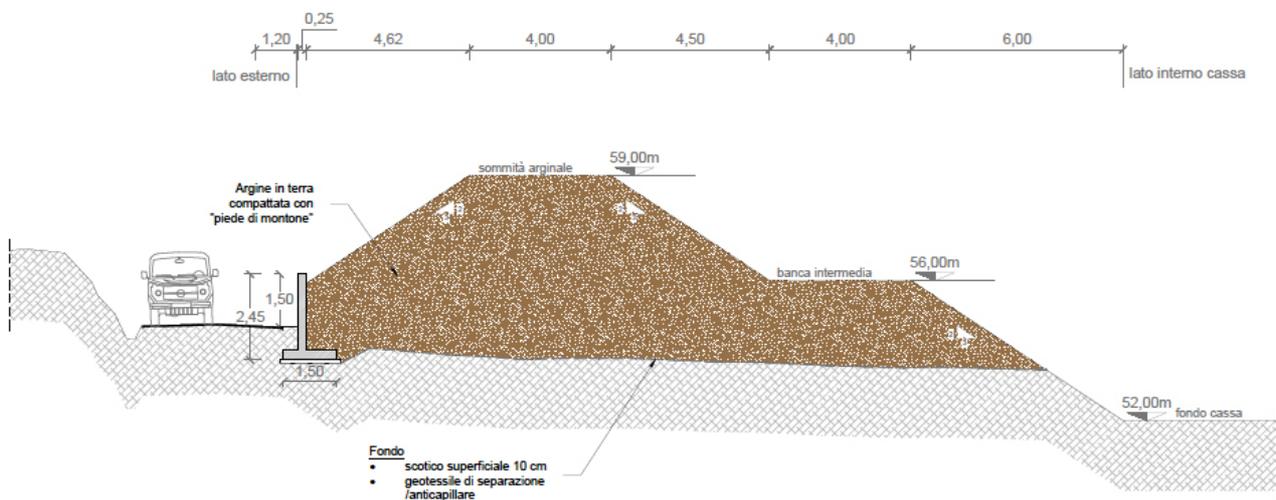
Sezioni tipo degli argini della cassa di espansione Sud.
